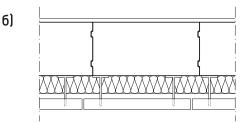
Двухслойные наружные стены из блоков YTONG с дополнительным утеплением скрепленной теплоизоляцией:
